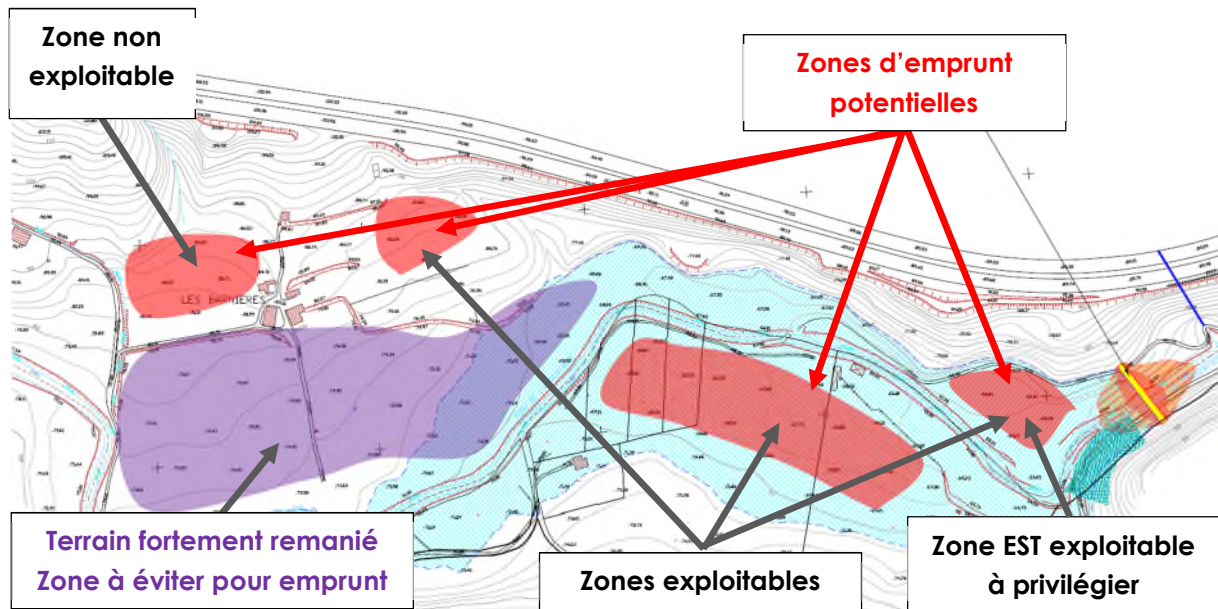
Plan de principe des zones potentielles d'emprunt investiguées au stade G2-AVP
